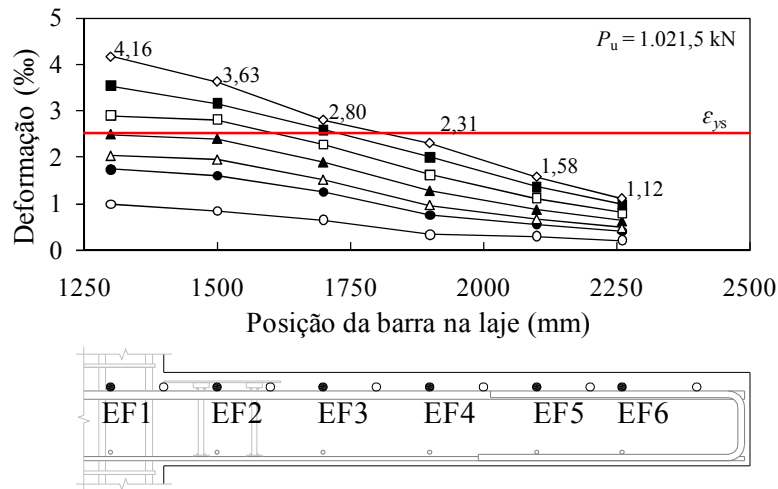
Deformações nas armaduras de flexão da laje LS01
